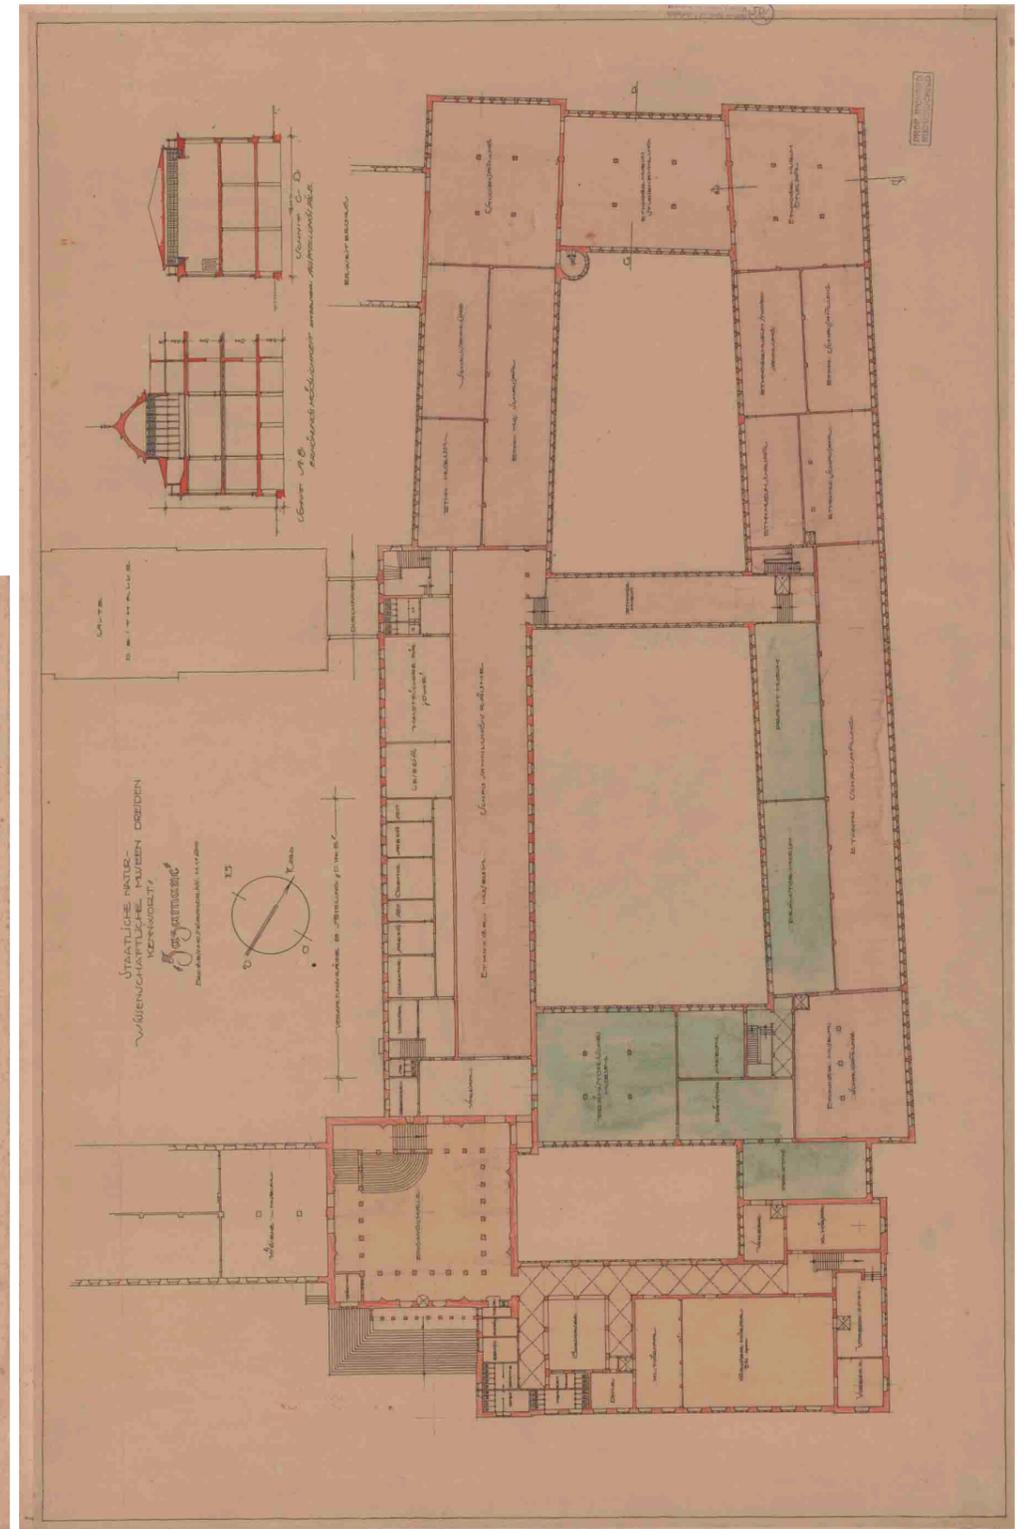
Bauabschnitt Staatliche Naturwissenschaftliche Museen (Grundriss EG)
